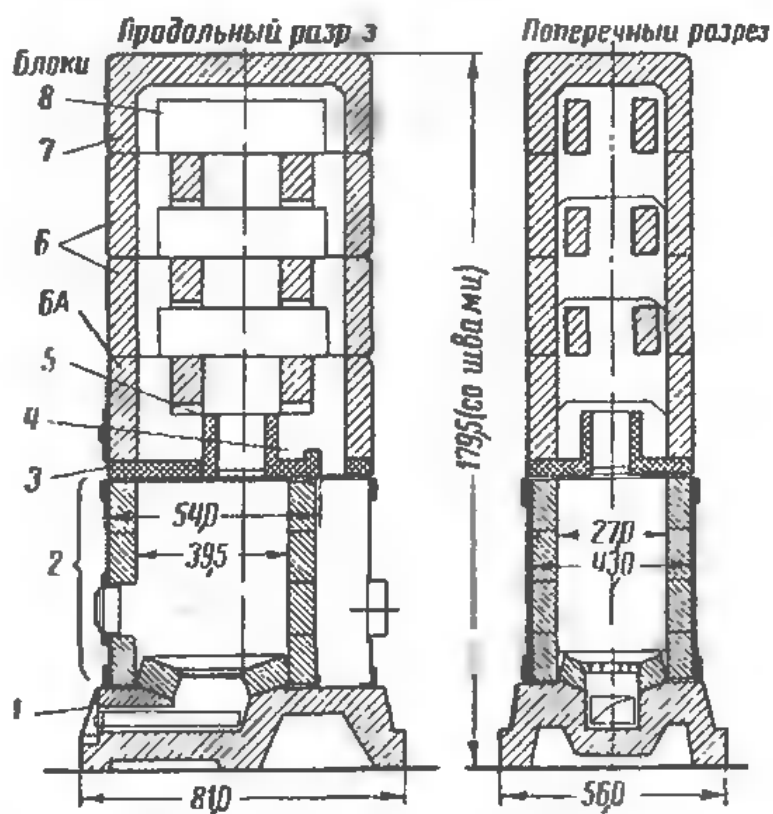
Сборно-блочная печь конструкции А. В. Хлудова (продольный и поперечный разрезы печи)
